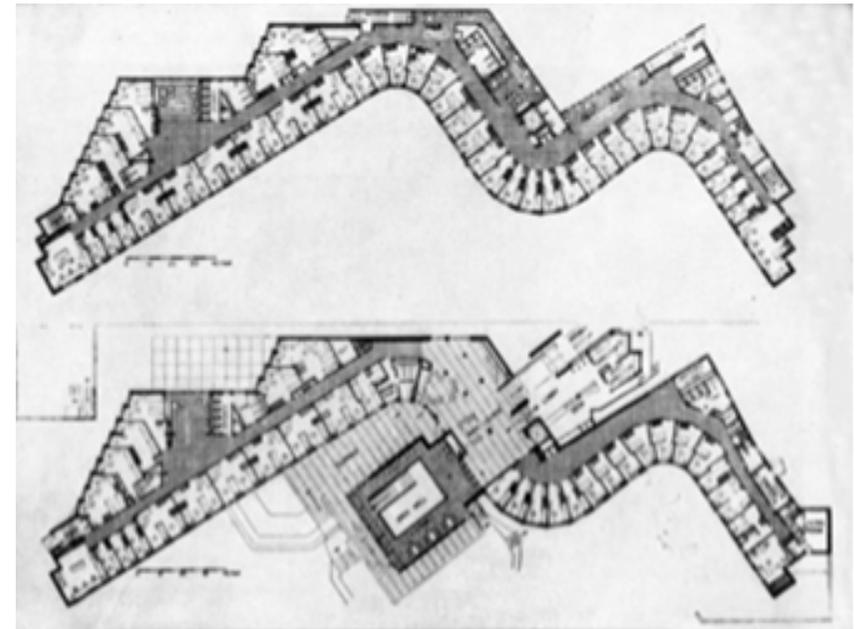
Planimetría Baker house. Fuente: Tectónica A. 2021
